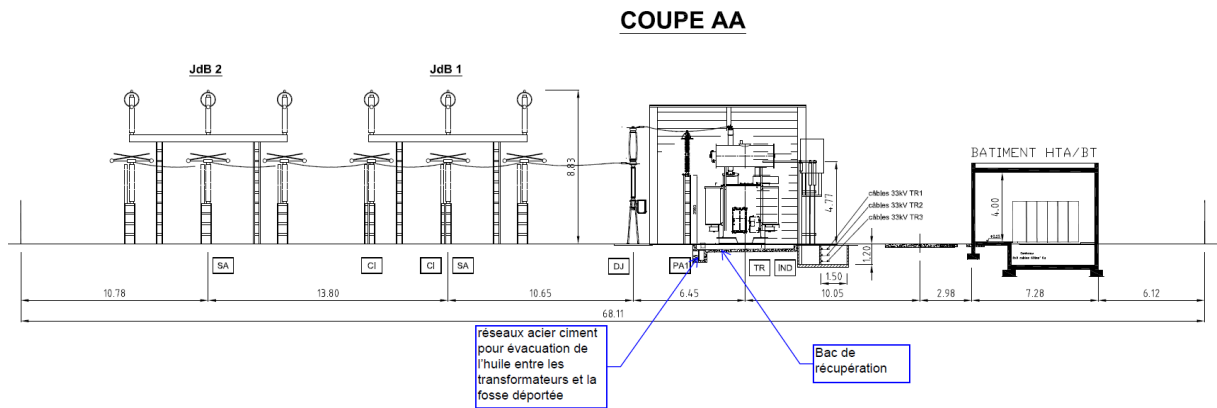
Plan en coupe de la sous-station – visualisation de la fosse
